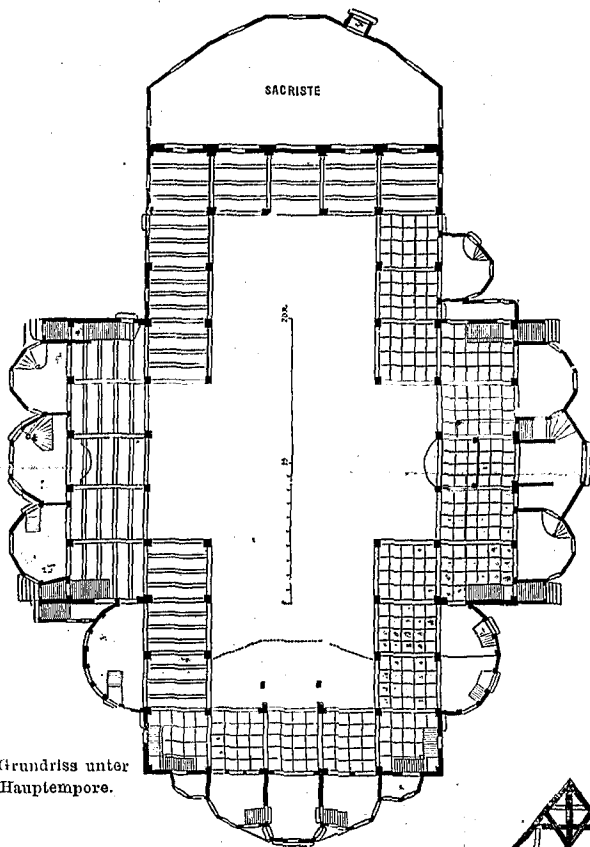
Grundriss unter der I. Hauptempore.
